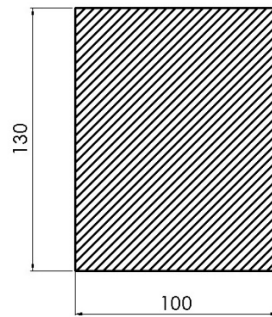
Dimensiones de la sección rectangular maciza en mm (Fuente: propia)
